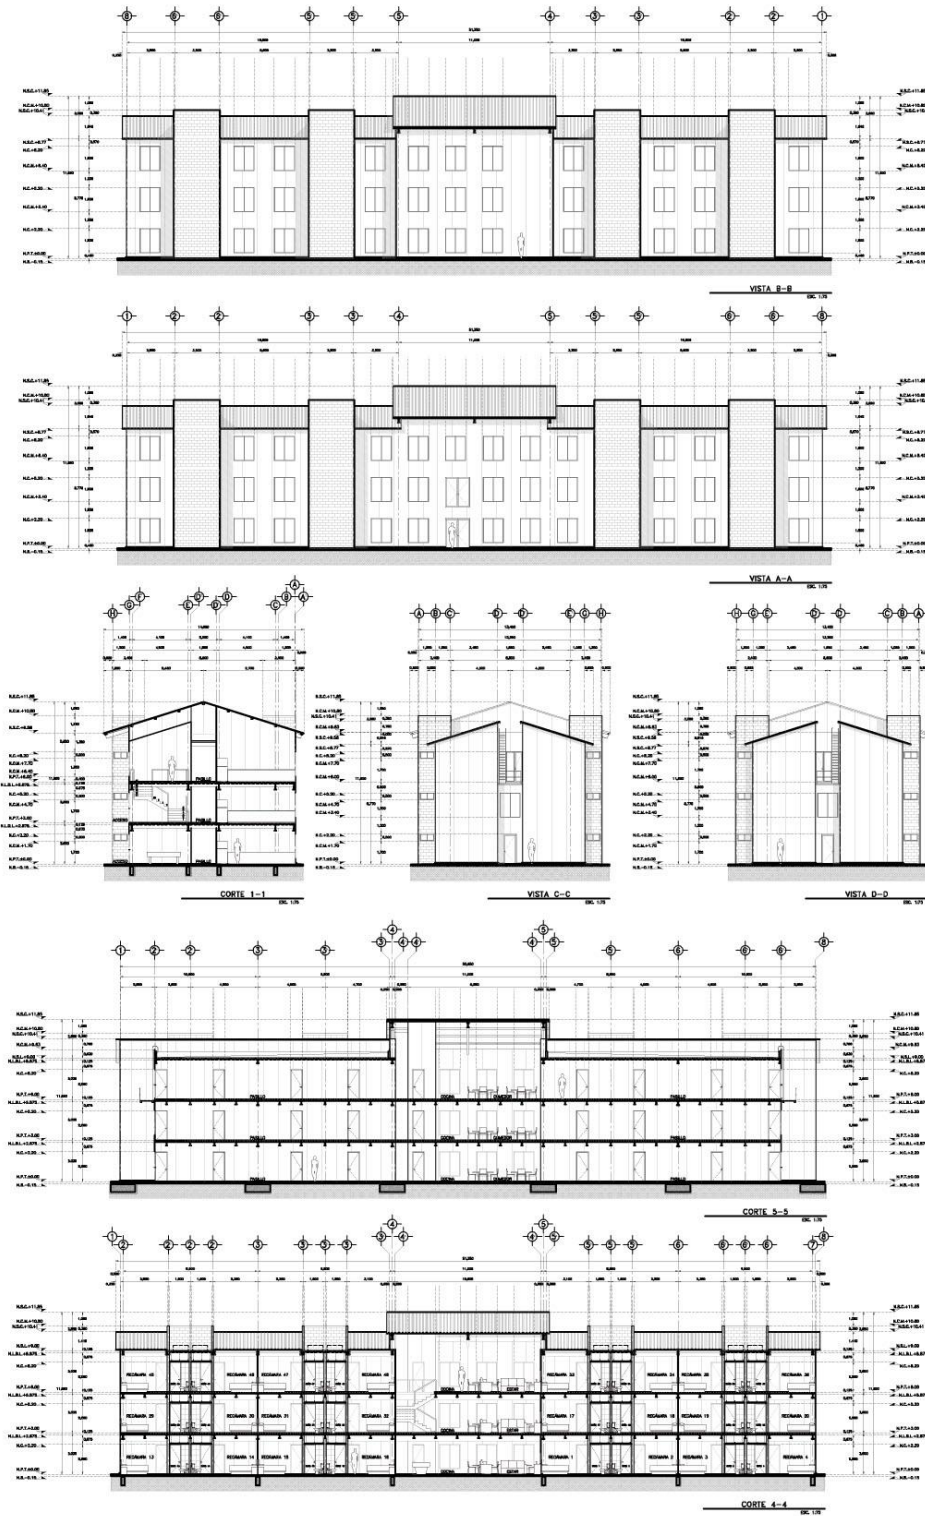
Fachadas y Cortes Dormitorio Módulo 1.
